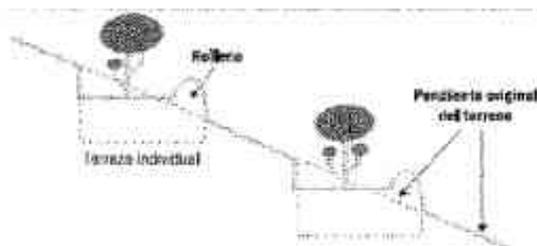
y 18. Construcción adecuada de la Terraza a cada uno de las plantas reforestadas
